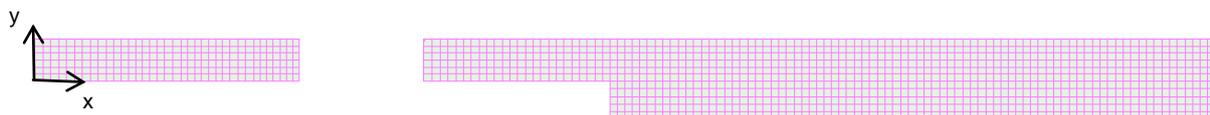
Sistema di riferimento - Vista in pianta soletta rampe/scale
